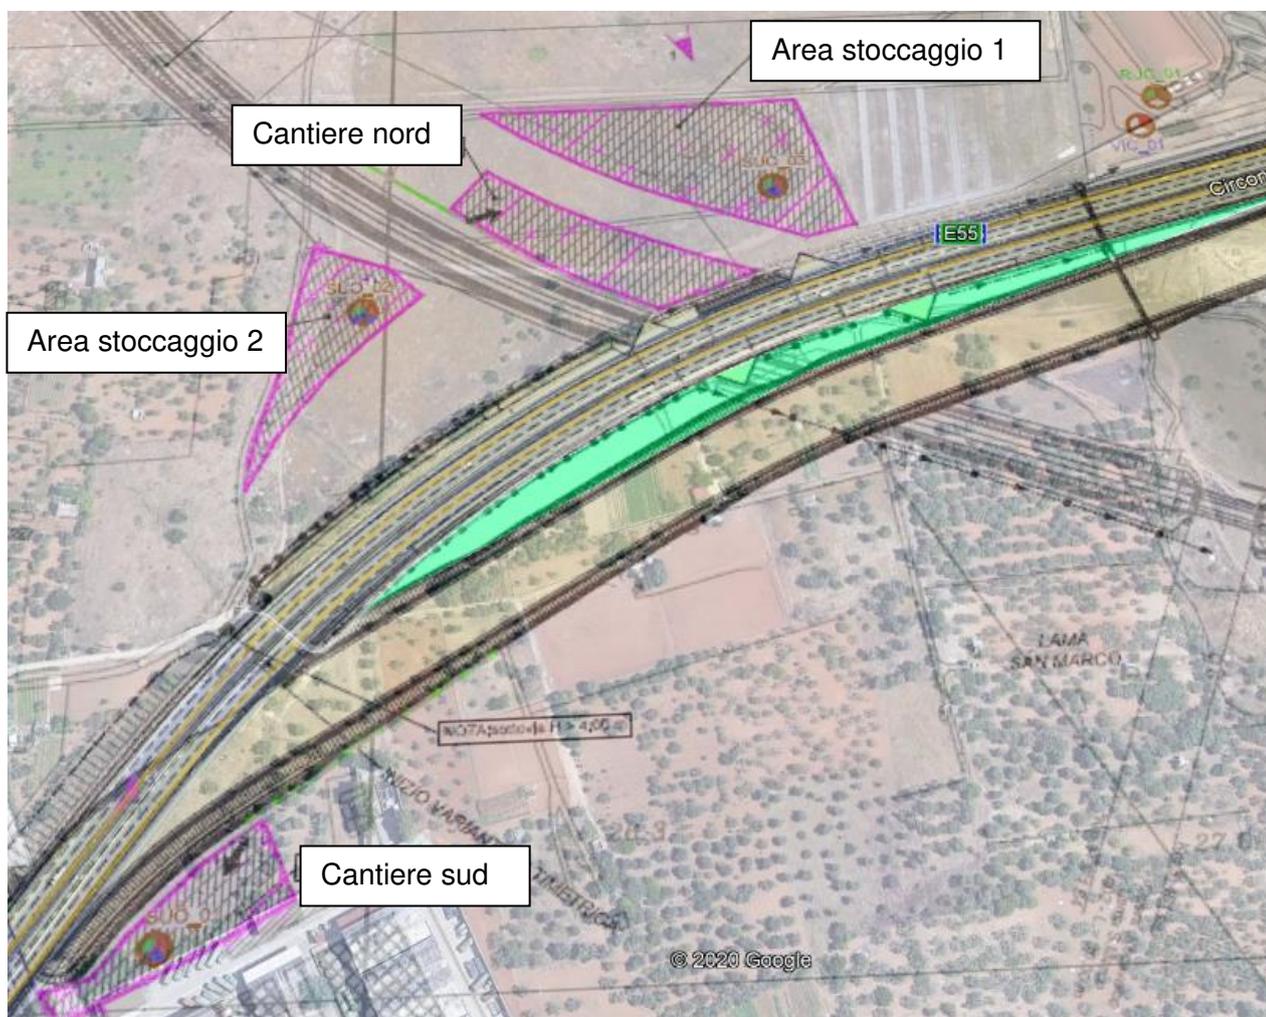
Localizzazione delle aree di cantiere e di stoccaggio
